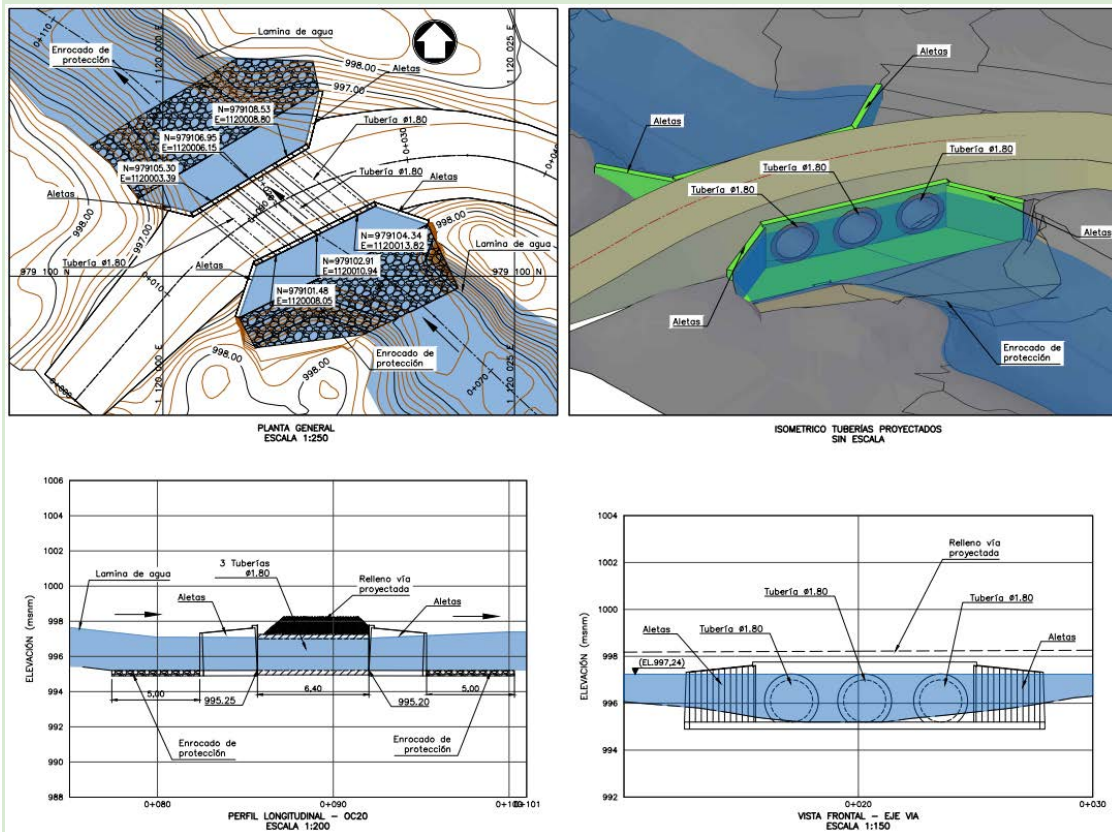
Implantación típica en planta - perfil y cortes para la obra OC20 con tubería de 1,8 m de diámetro y tres celdas.
